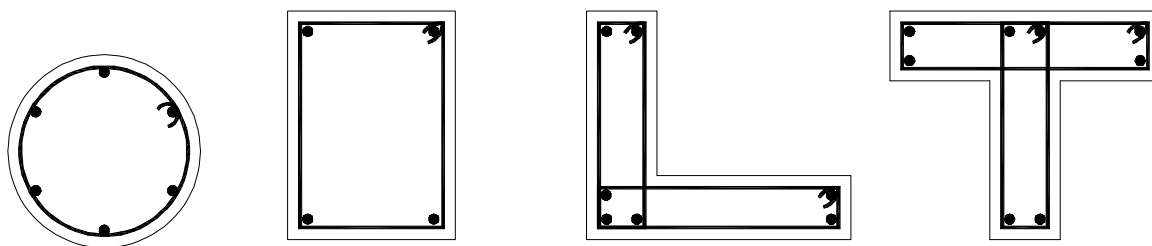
Disposição das barras longitudinais mínimas para diversas seções
